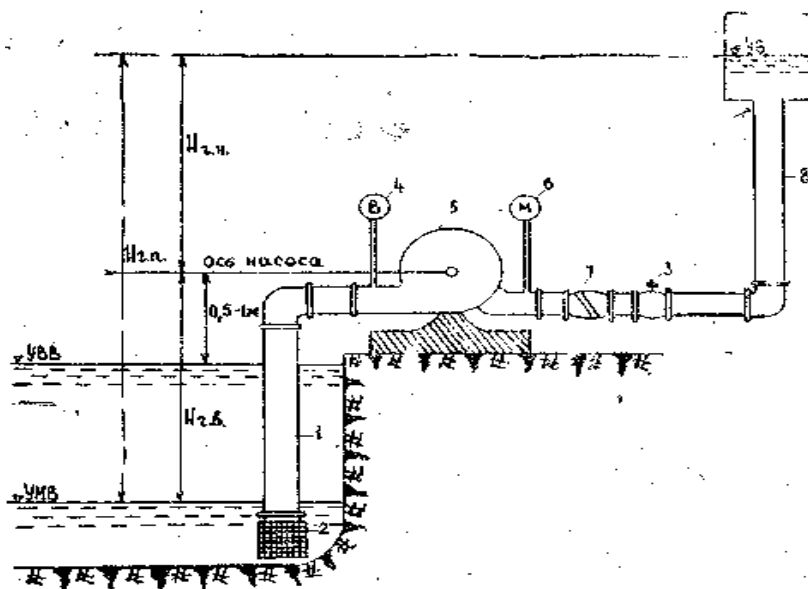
Схема и арматура насосной установки. 1 - всасывающий трубопровод; 2 - приемный клапан; 3 - задвижка; 4 - вакуумметр; 5 - насос; 6 - манометр; 7 - обратный клапан; 8 - напорный трубопровод; Нгп - геодезическая высота подъема; Нгв - геодезическая высота всасывания; Нгн - геодезическая высота нагнетания.
